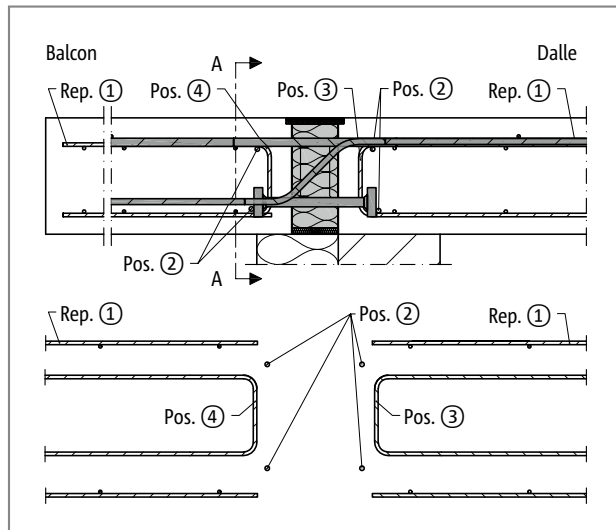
Schöck Isokorb® T Type K-M12 : Renforcement sur site pour support direct
